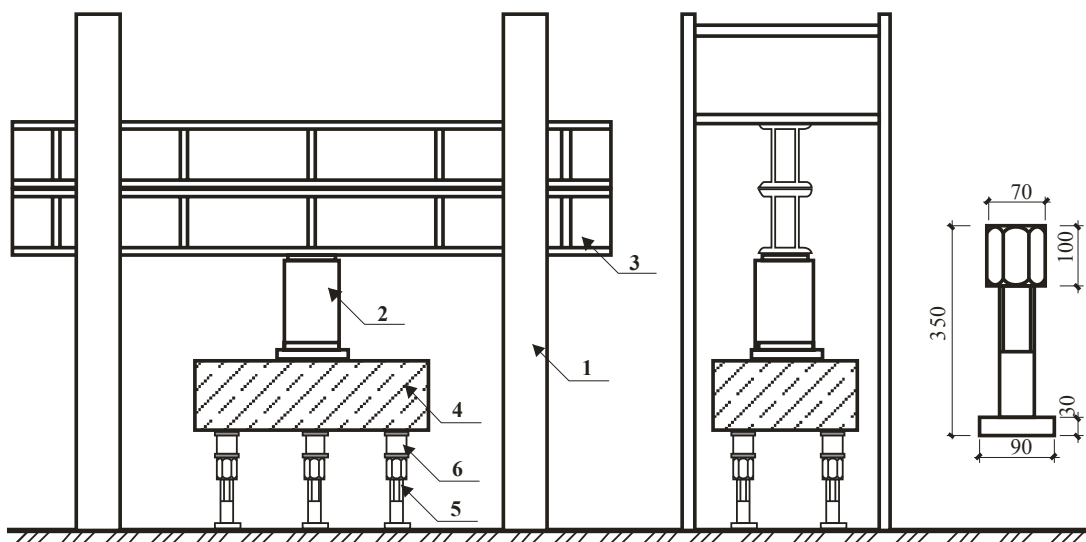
Схема силовой установки для испытаний многорядных свайных ростверков под колонны:
